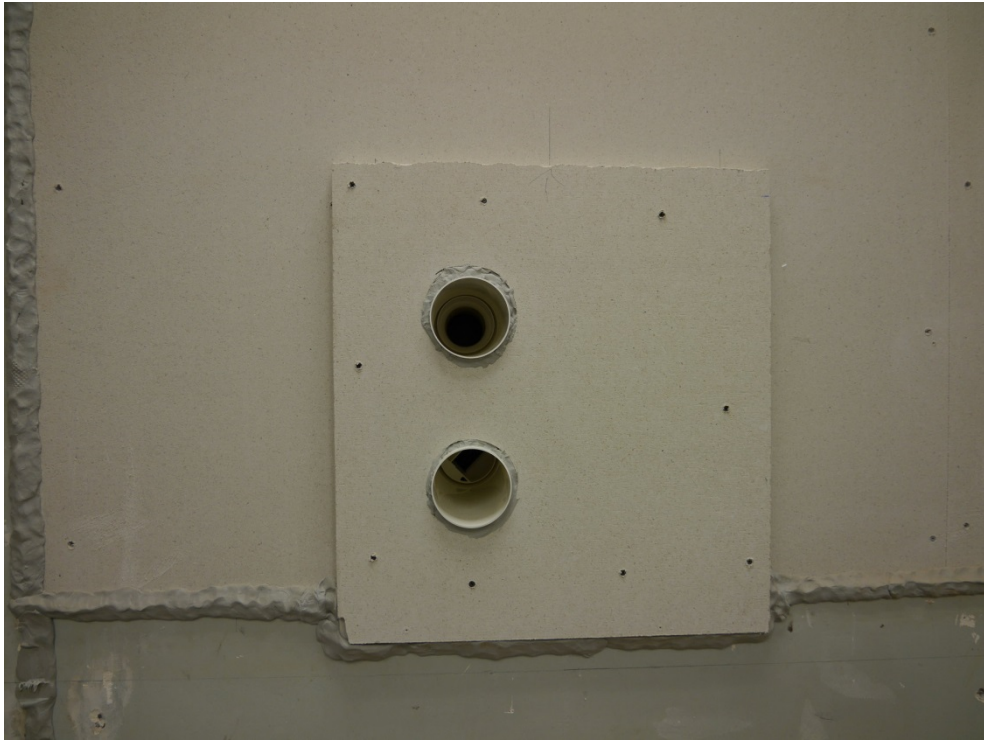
Variante Standardfassadenabschluss ES: Lüftungsöffnungen außenseitig (Außenluft oben, Fortluft unten), Fassadenabschluss noch nicht montiert.
